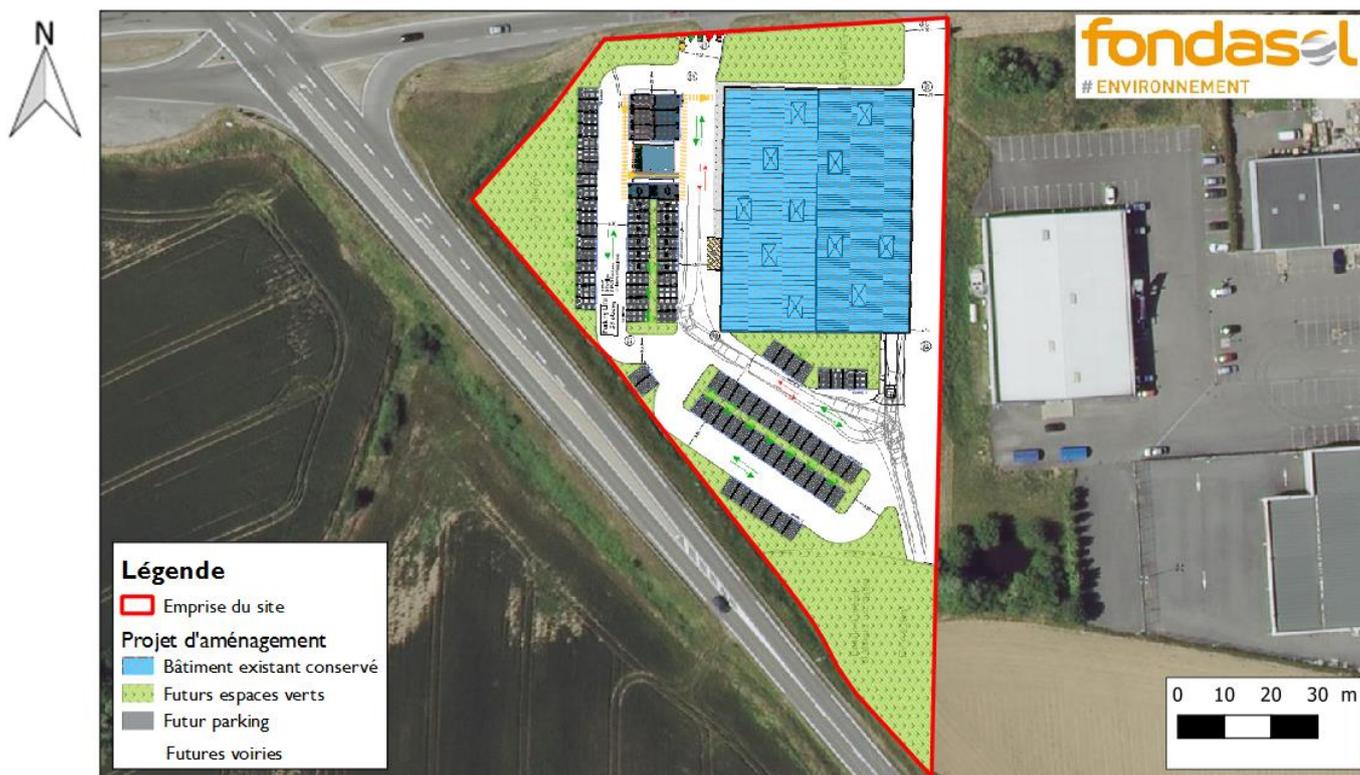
Plan de masse du projet d'aménagement (Source : plan de masse en date du 27/01/2020 transmis par LIDL)
